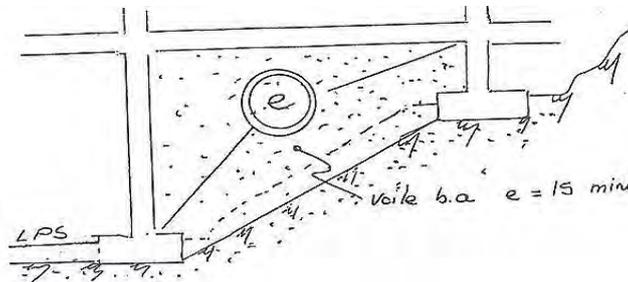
Liaison des semelles situées sur des niveaux différents. Un voile en BA est nécessaire si la différence de hauteur d'implantation est supérieure à la limite autorisée. (Document JM Perrissol pour EAML)
